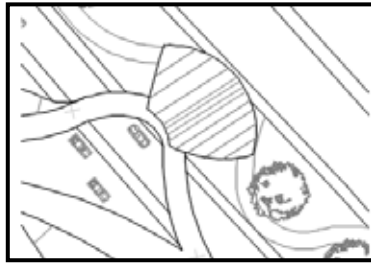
Acceso A-2 planta techo nivel +12,00m. (2017)
